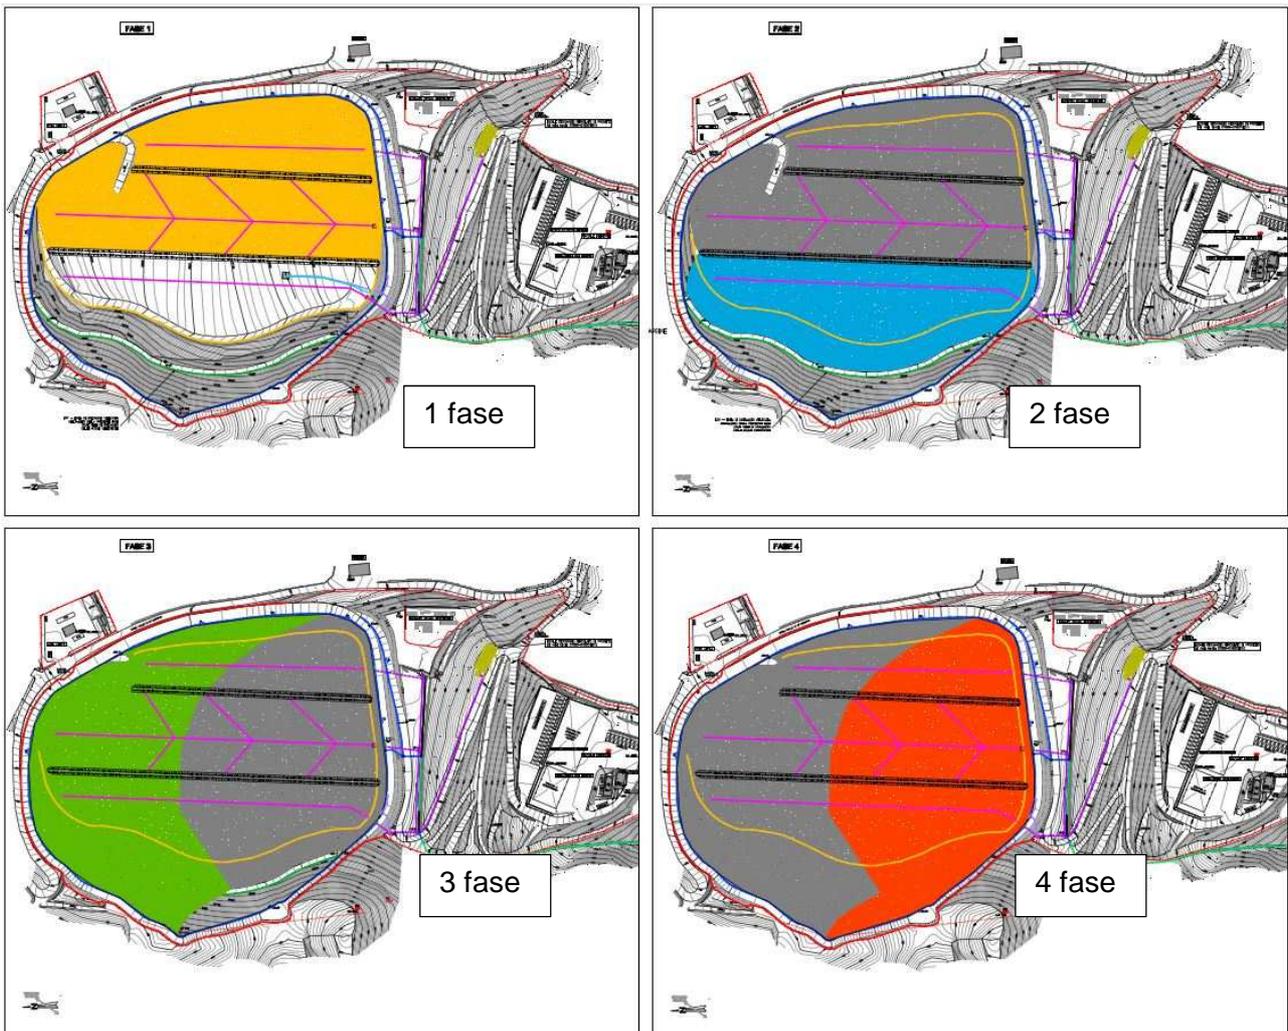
estratto della "*Planimetria delle fasi di abbancamento*" approvata
